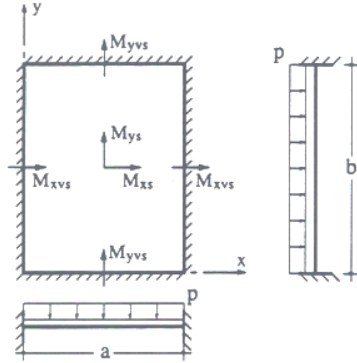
Laje bi-encasturada, adaptado de [9]
